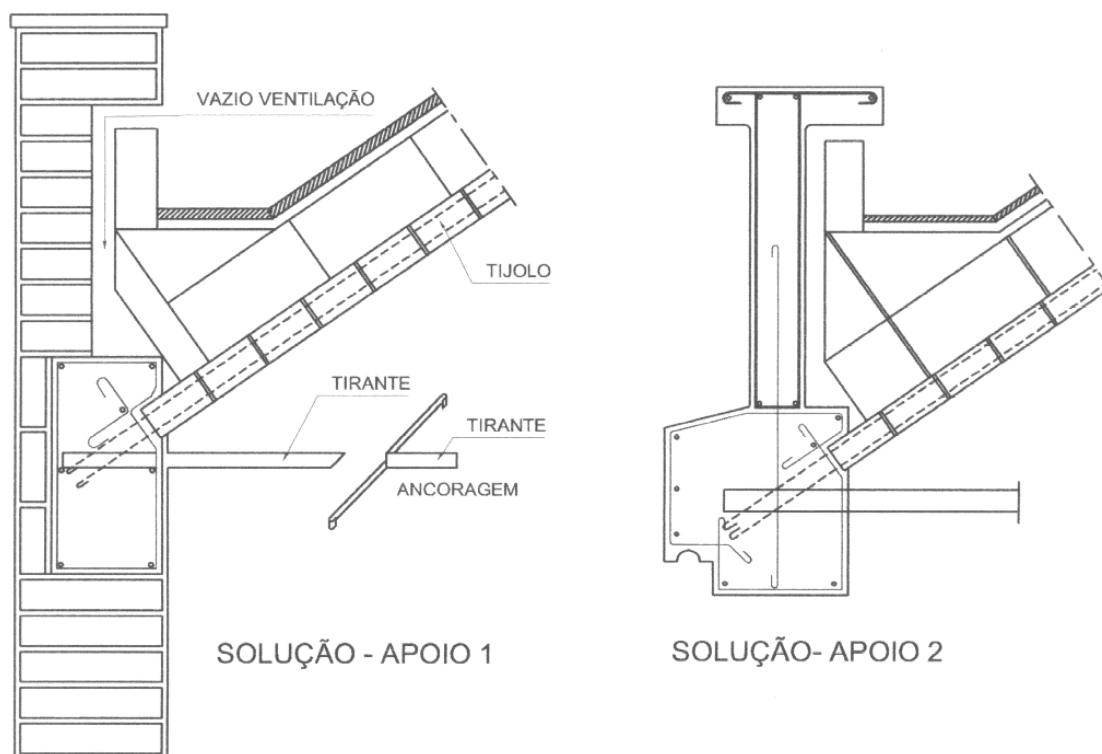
Casa Berlinghieri: soluções de apoio para abóbada autoportante (DIESTE, 1947).
